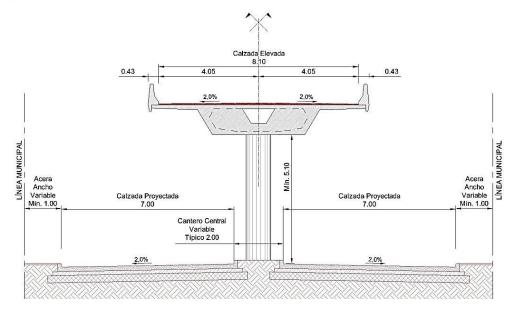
Perfil tipo del primer tramo de la Av. Lugones norte, hasta calle Sáenz Peña.
